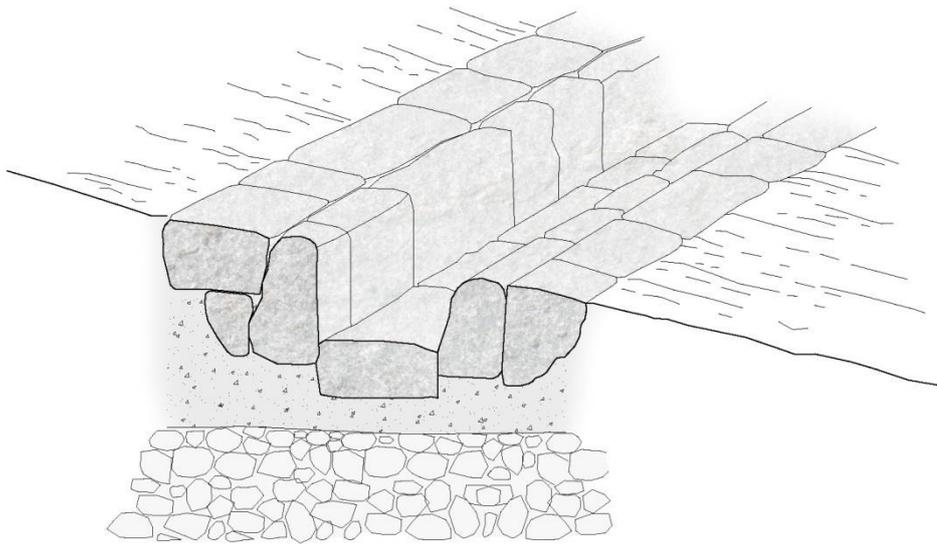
Dettaglio canaletta trasversale in pietra arenaria, scala 1:20.
